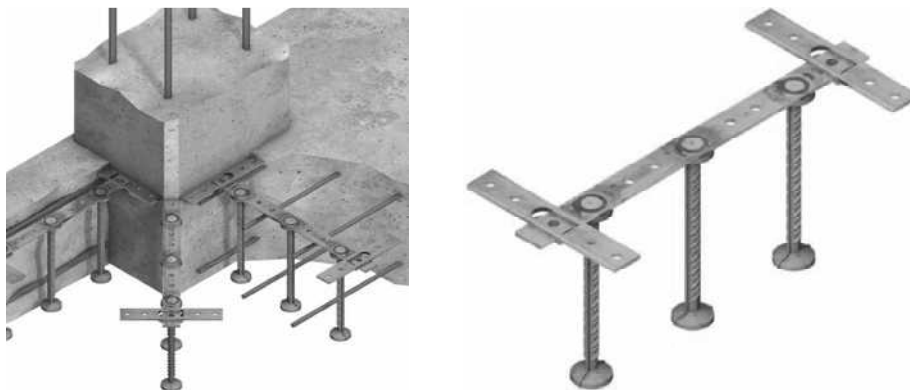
Detalhes do sistema de armaduras da HALFEN DEHA
